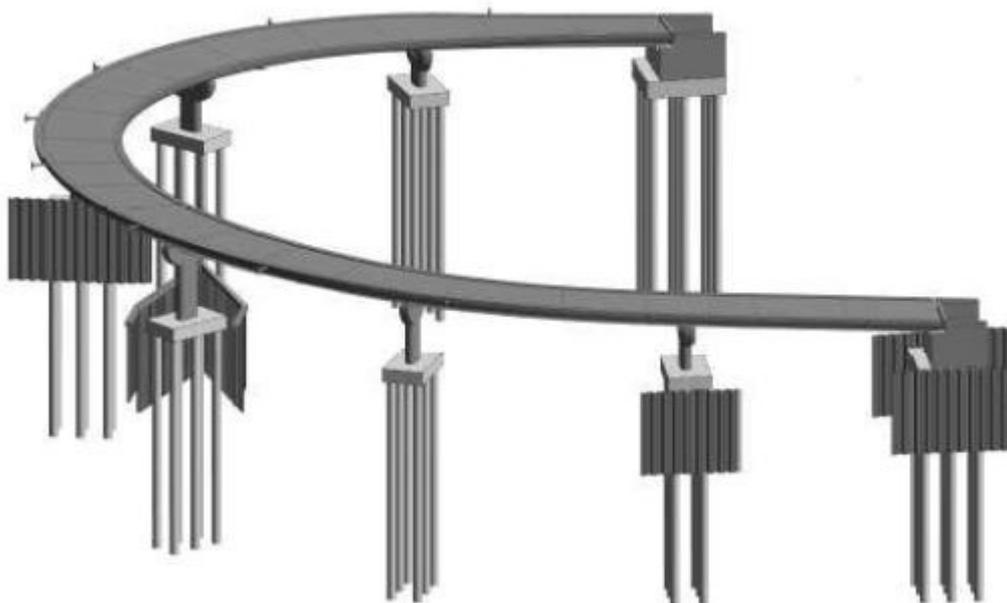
Sovrappasso di ingresso - Vista assonometrica
